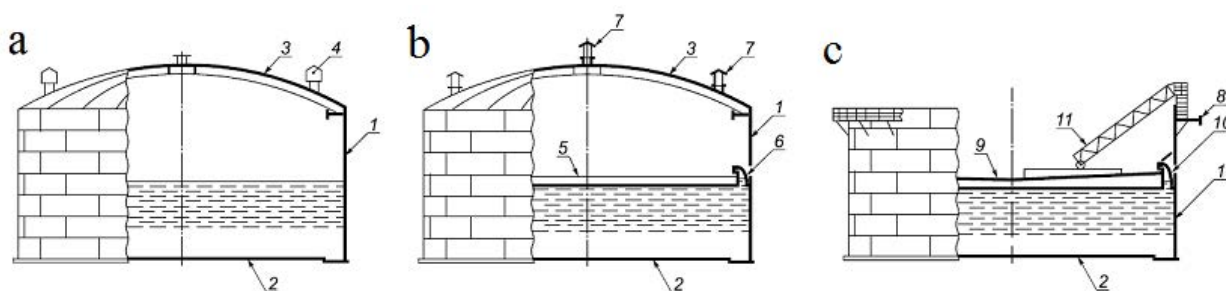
Схемы стальных цилиндрических резервуаров [5]:
